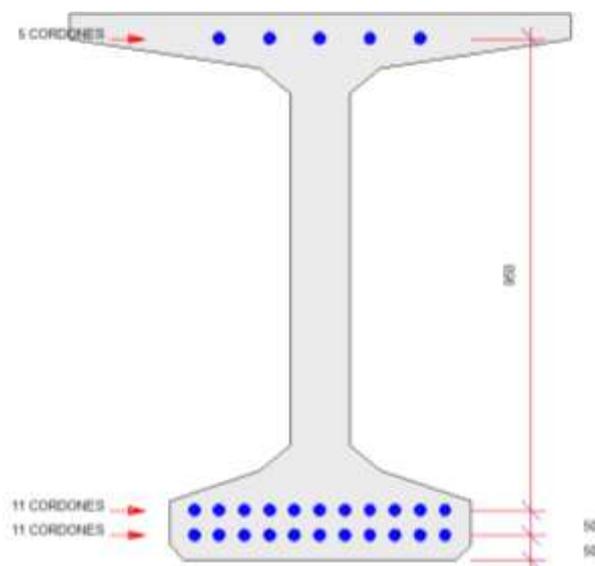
Armadura activa de las vigas. Fuente: El. prop.
